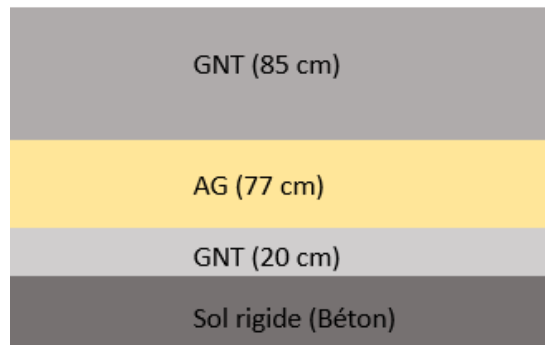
Structure de chaussée de la plateforme support de classe PF2
